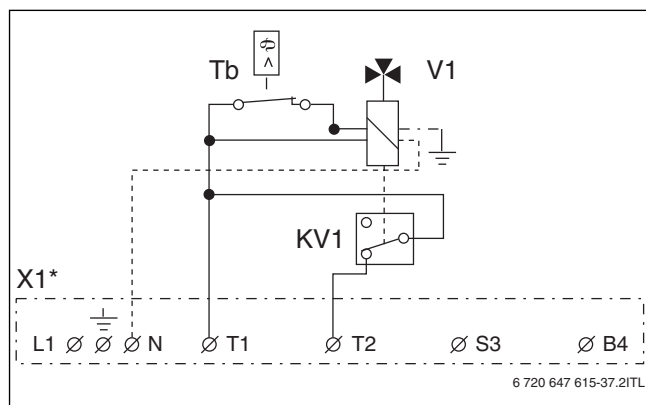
3-cestný ventil regulovaný zapínacím kontaktom
